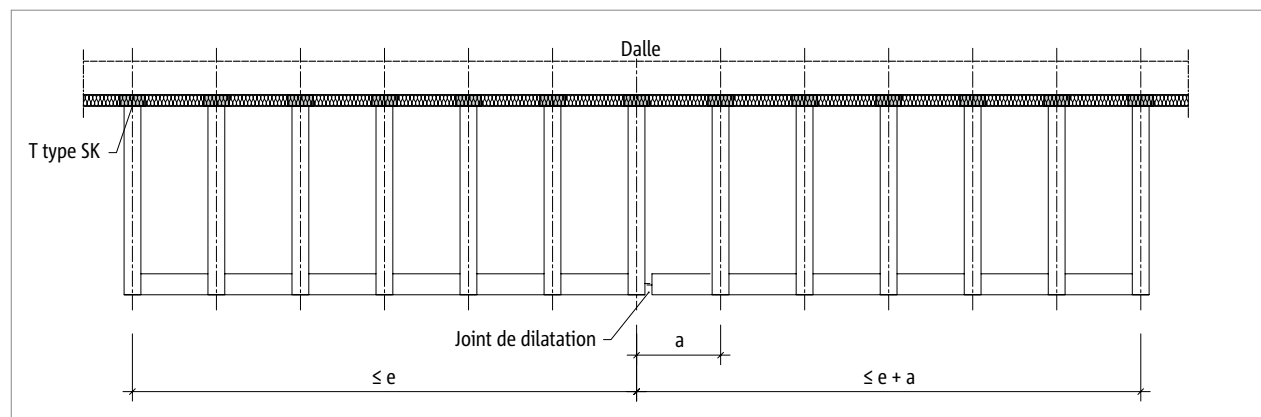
Schöck Isokorb® T type SK : distance maximale entre joints de dilatation e
